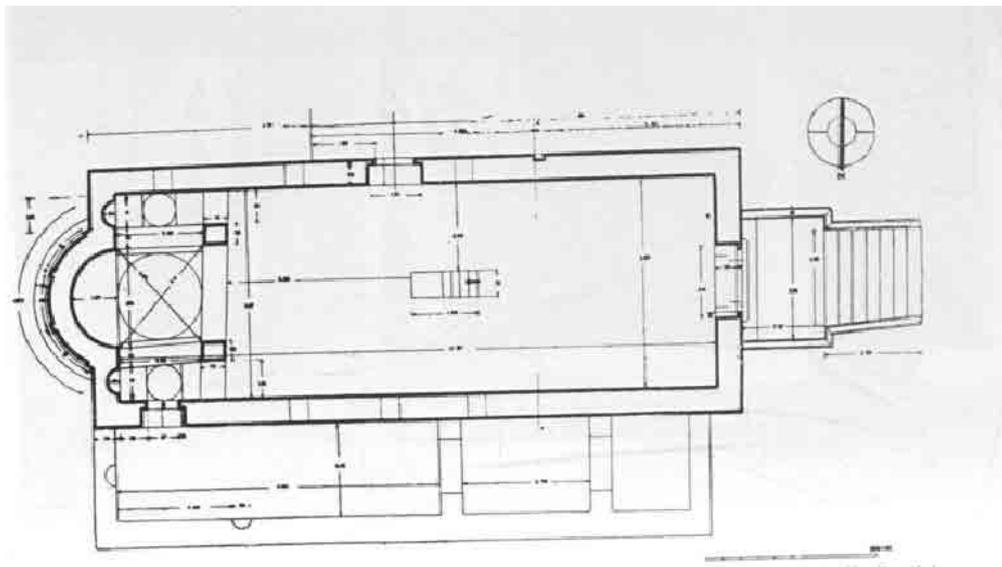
Mili San Pietro, Santa Maria, pianta
